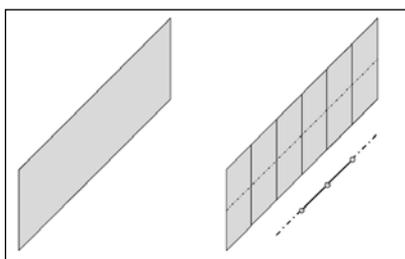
Elemento parete intera e elemento di parete formato da più elementi con giunti verticali.
